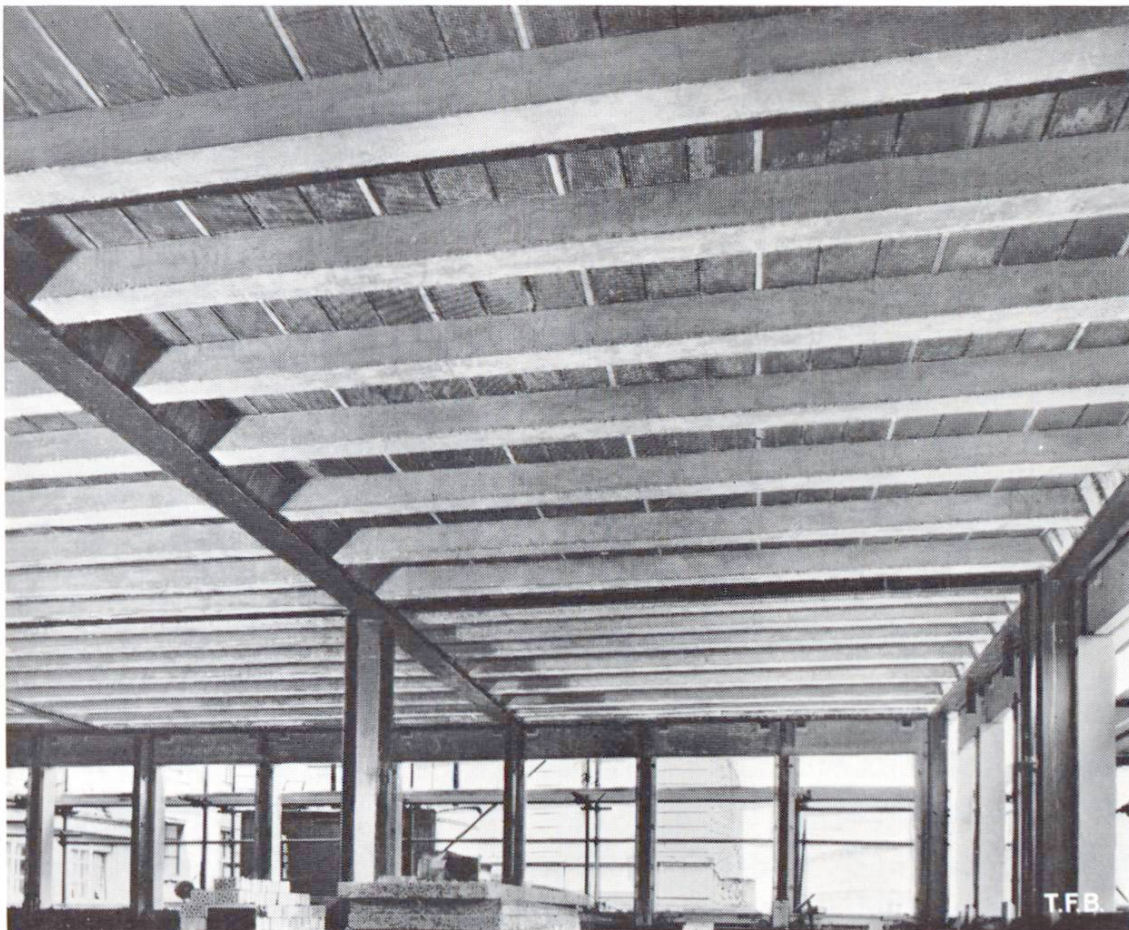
Deckenkonstruktion aus vorfabrizierten vorgespannten Betonbalken mit dazwischen verlegten Tonhourdis und Überbeton. Nutzlast 500 kg/m<sup>2</sup>, Spannweite 4,5–7,5 m
